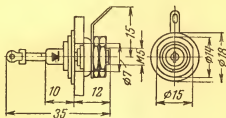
Габаритный чертеж диодов Д202—Д205.
